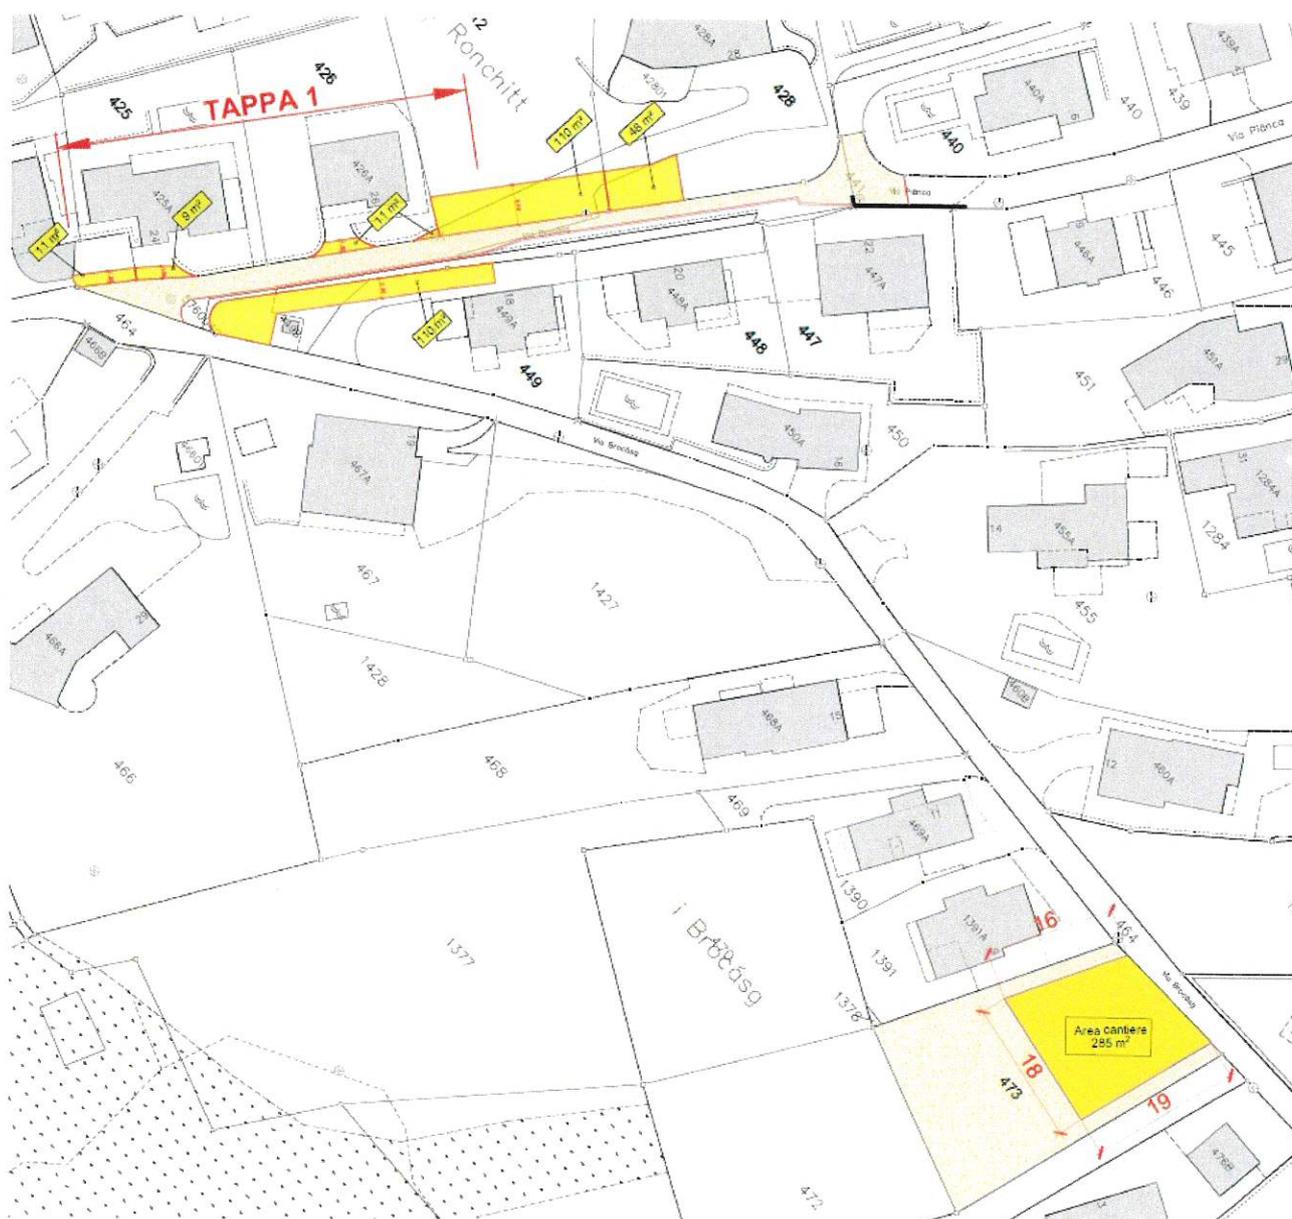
Estratto planimetria 28-18.108 con i mappali interessati dall'occupazione temporanea.
